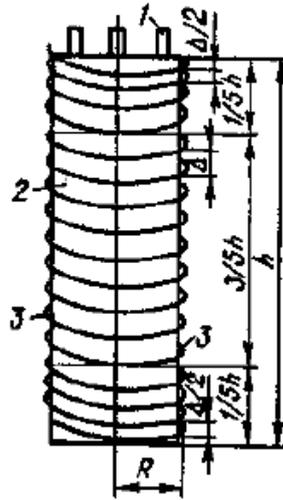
Схема індукційного прогрівання: 1 – арматурний стержень; 2 – опалубка; 3 – індуктор
